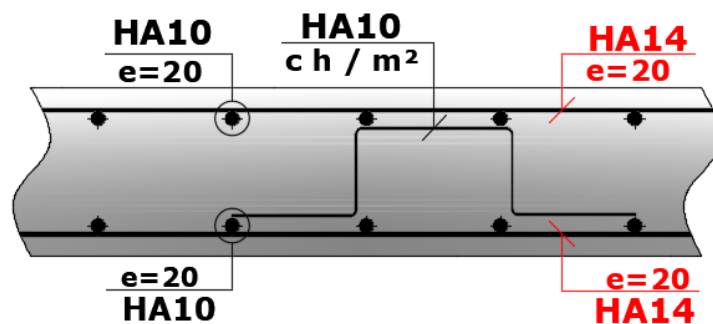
Ferrailage de la dalle (coupe transversale).
